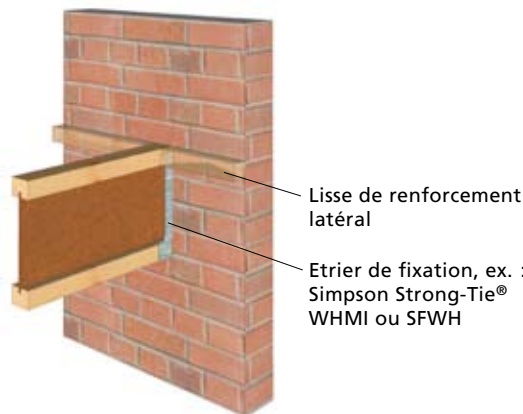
DETAILS DE CONSTRUCTION POUR LES PLANCHERS
